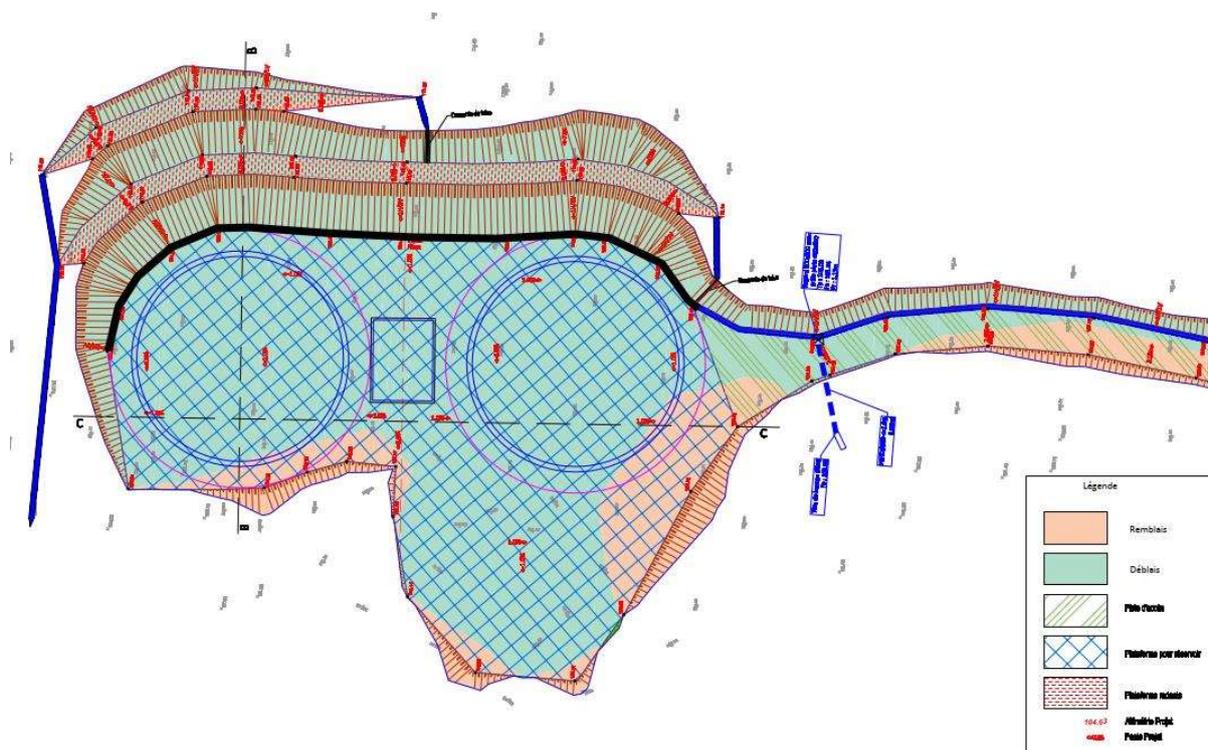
implantation générale de l'ouvrage de soutènement (trait noir) sur le plan EXE de terrassement
